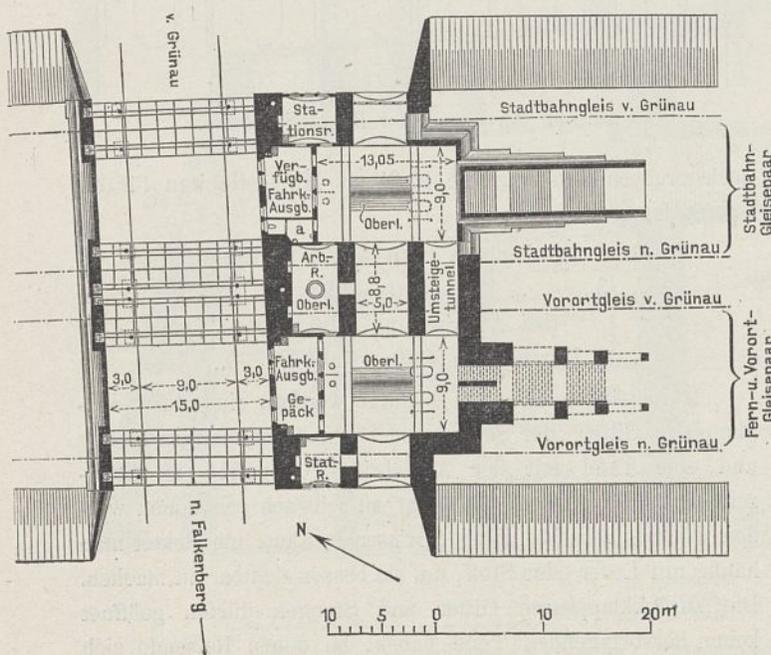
Haltestelle Grünau. Erdgeschöß. Nördlicher Aufgang.
